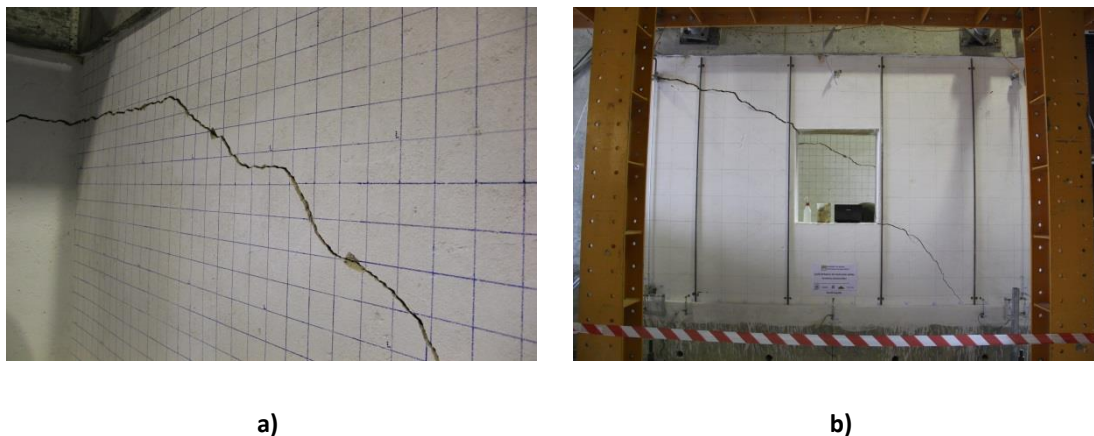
Fissuras resultantes do 1º Ciclo: a) Interior da fachada Norte b) Exterior da fachada Sul
